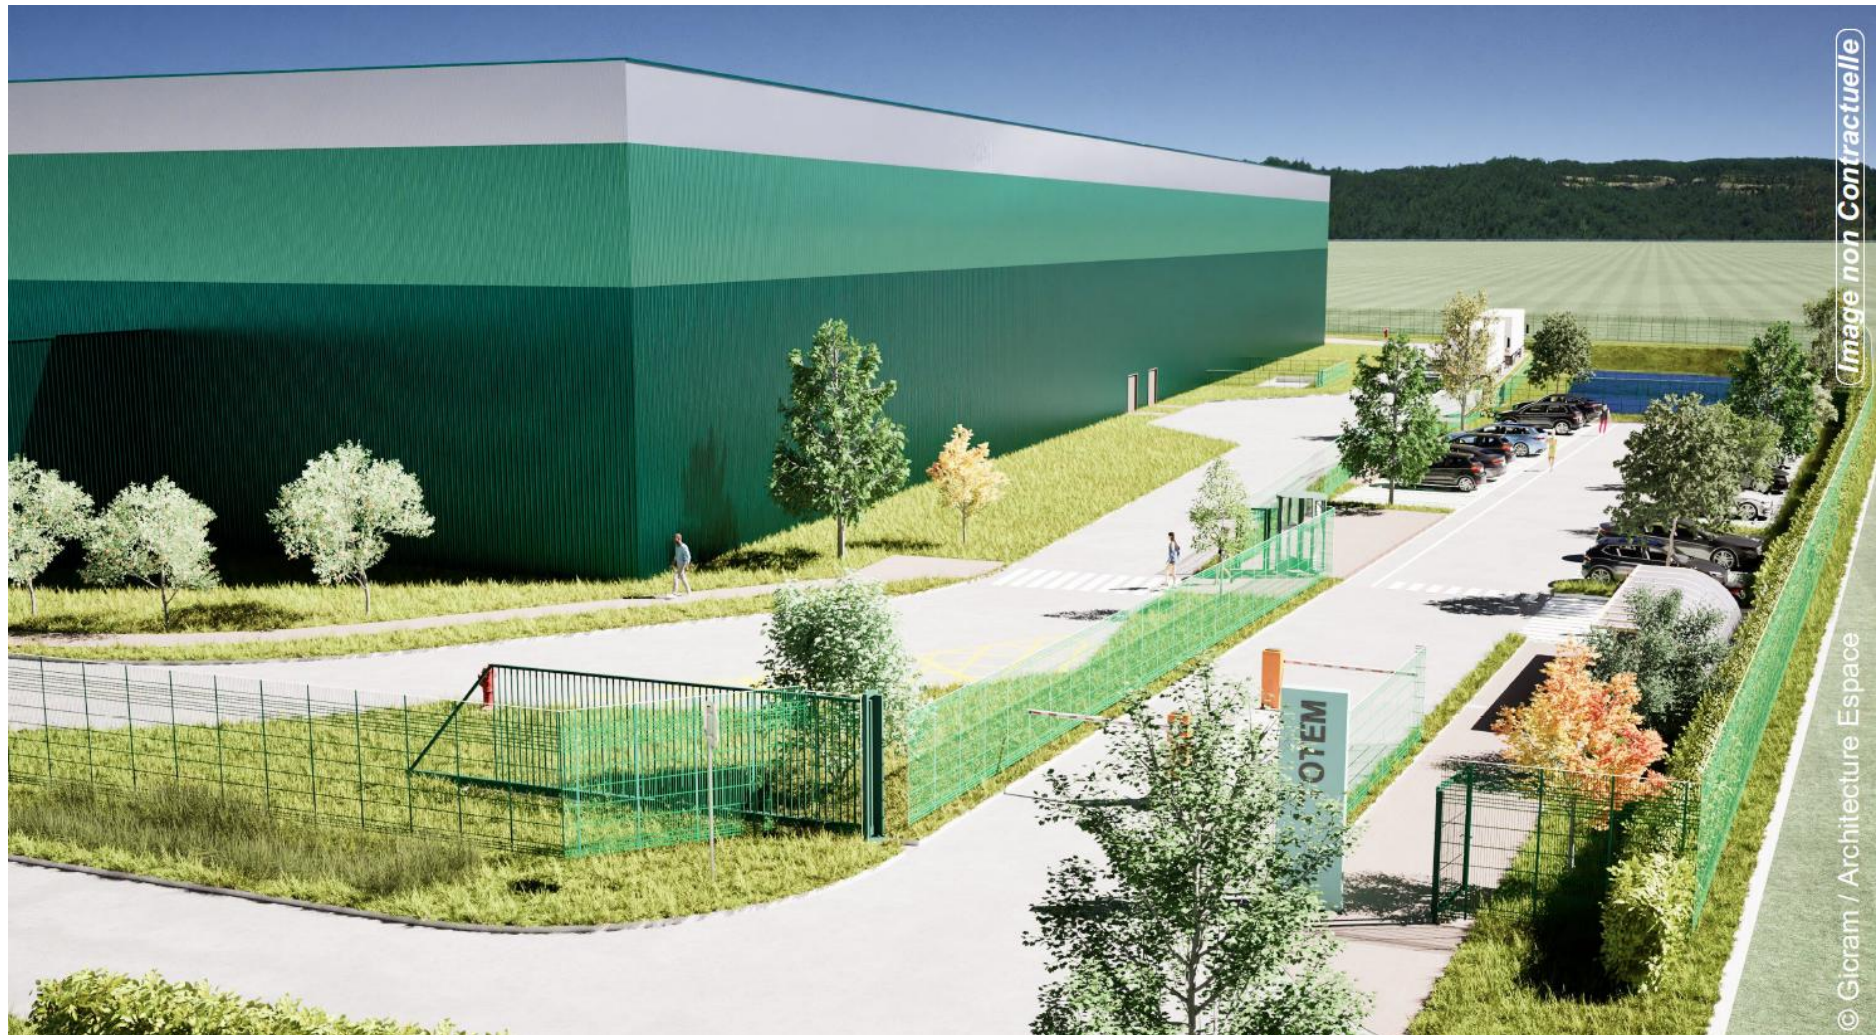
Vue du parking VL – Façade Ouest (Source : Permis de Construire)
